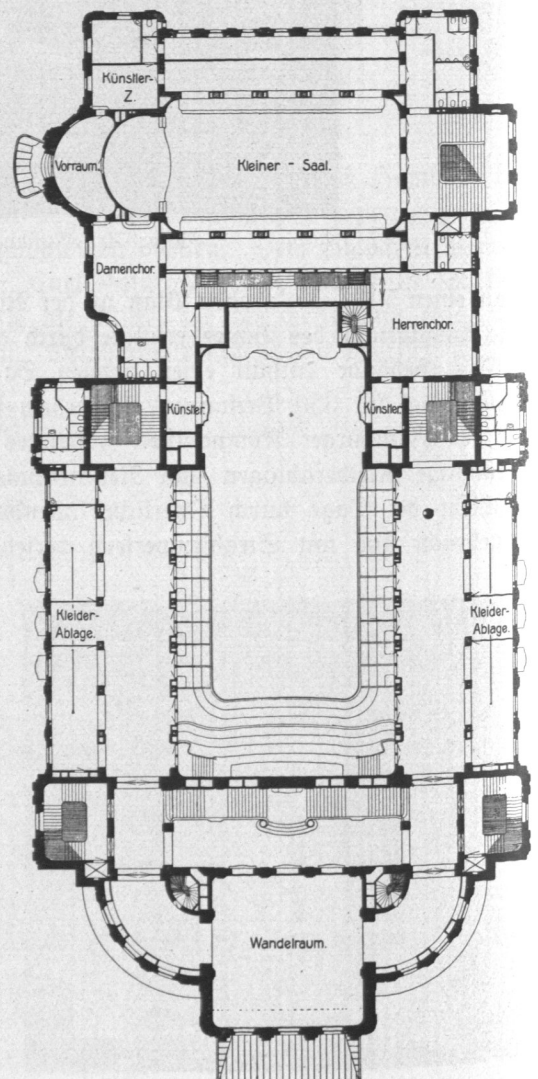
Musikhalle, Obergeschoß, Grundriß.
